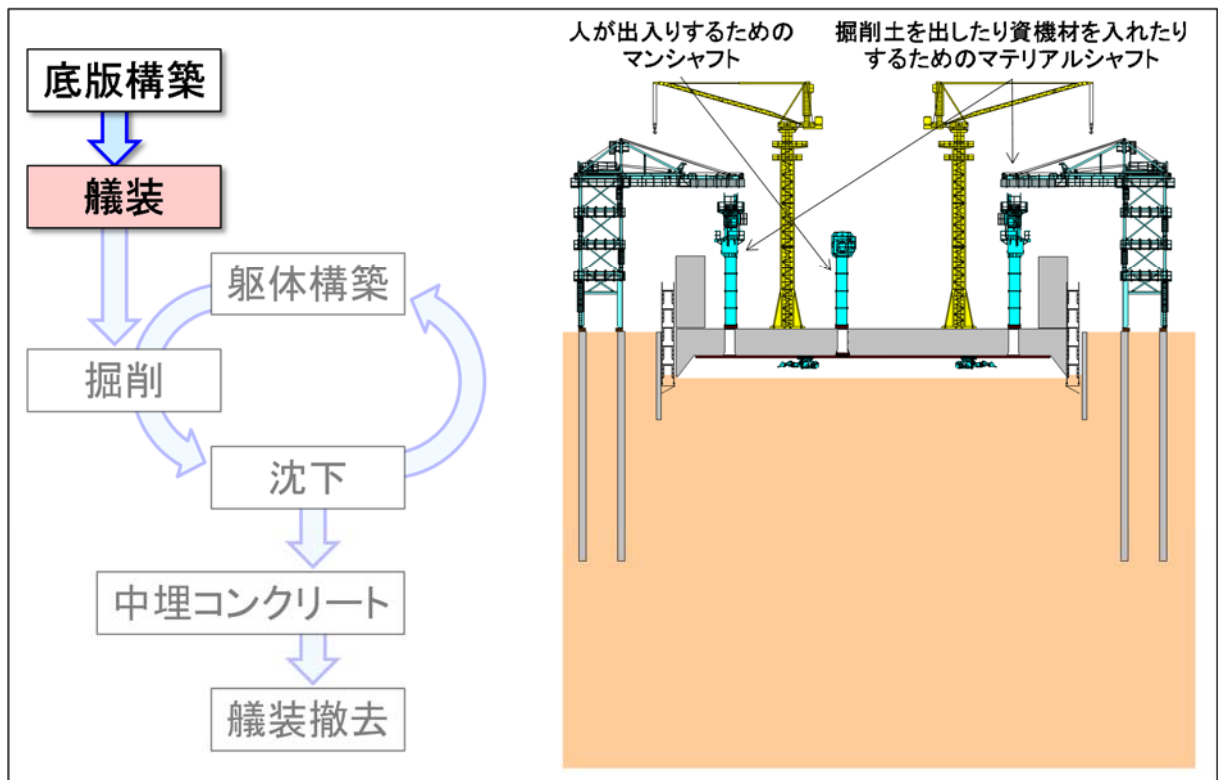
(4) ニューマチックケーソン工（艀装）の概要
